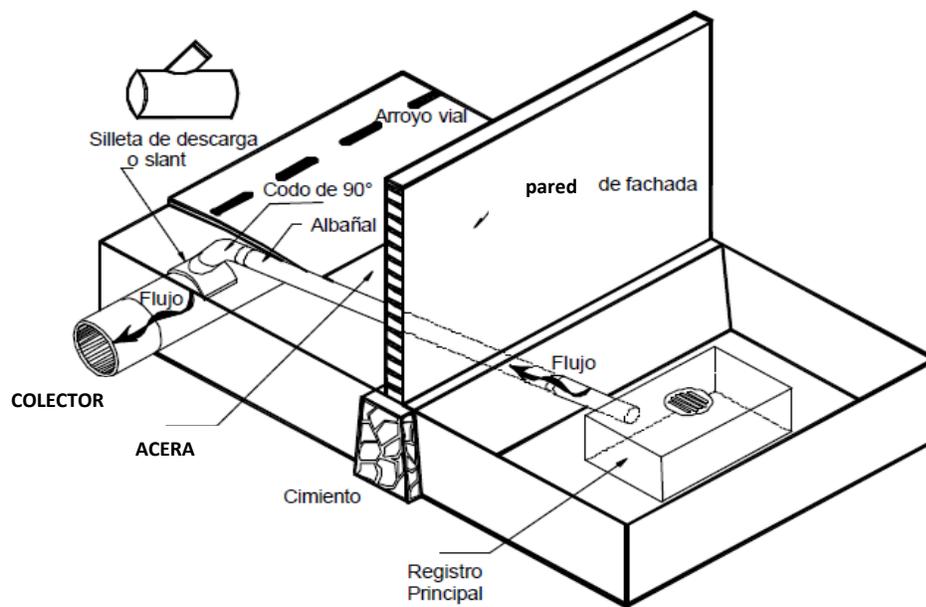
Detalle de acometida domiciliar a alcantarillado pluvial
